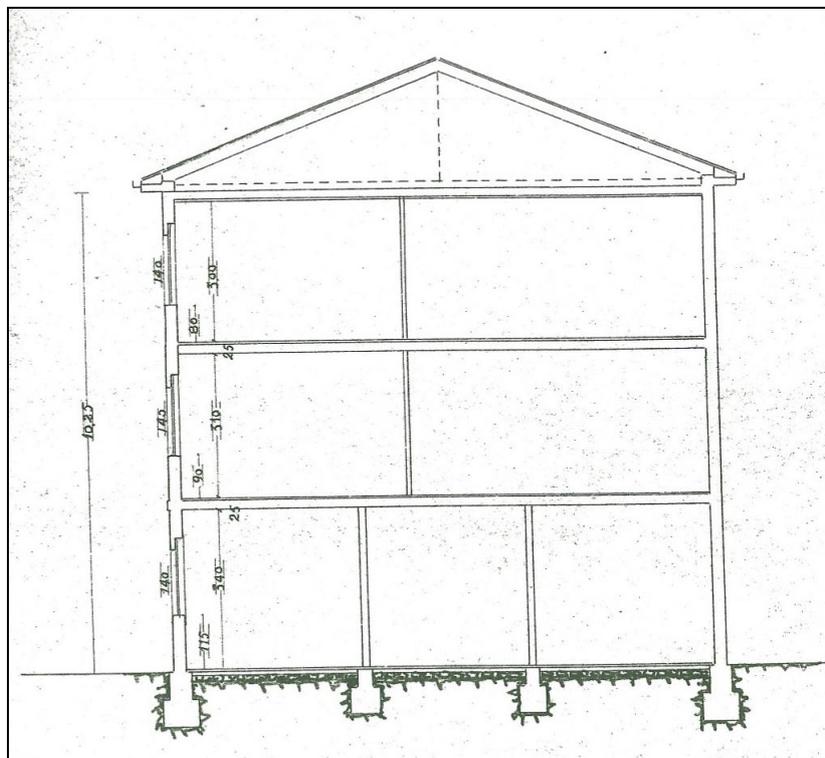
b. Stato approvato: Sezione Autorizzazione Edilizia del 05.07.1954.
